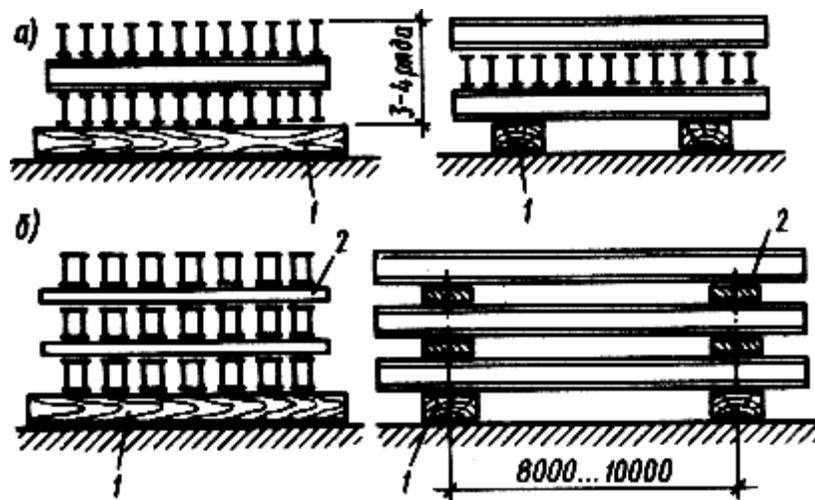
Складирование стальных элементов конструкций в многоярусных штабелях: а - одностенчатых балок с вертикальным положением их стенок; б - двухстенчатых элементов конструкций; 1 - лежни-подкладки; 2 - прокладки
